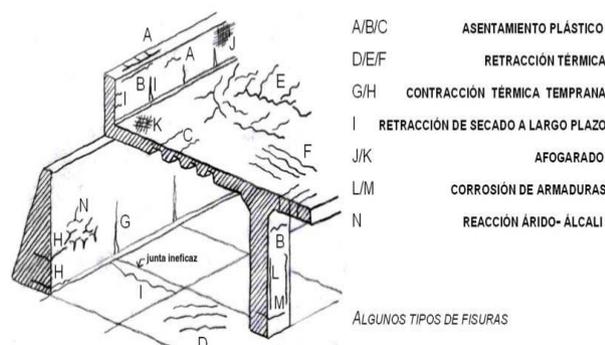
Tipos de Fisuras en el Hormigón.
